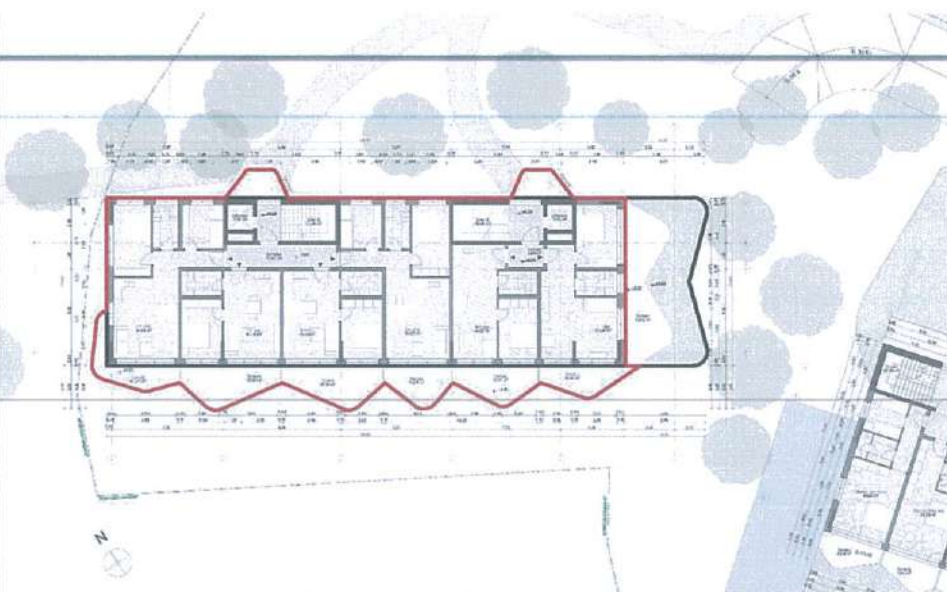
Planimetria e katit të tretë – Sip. kati të tretë 529.2m²
